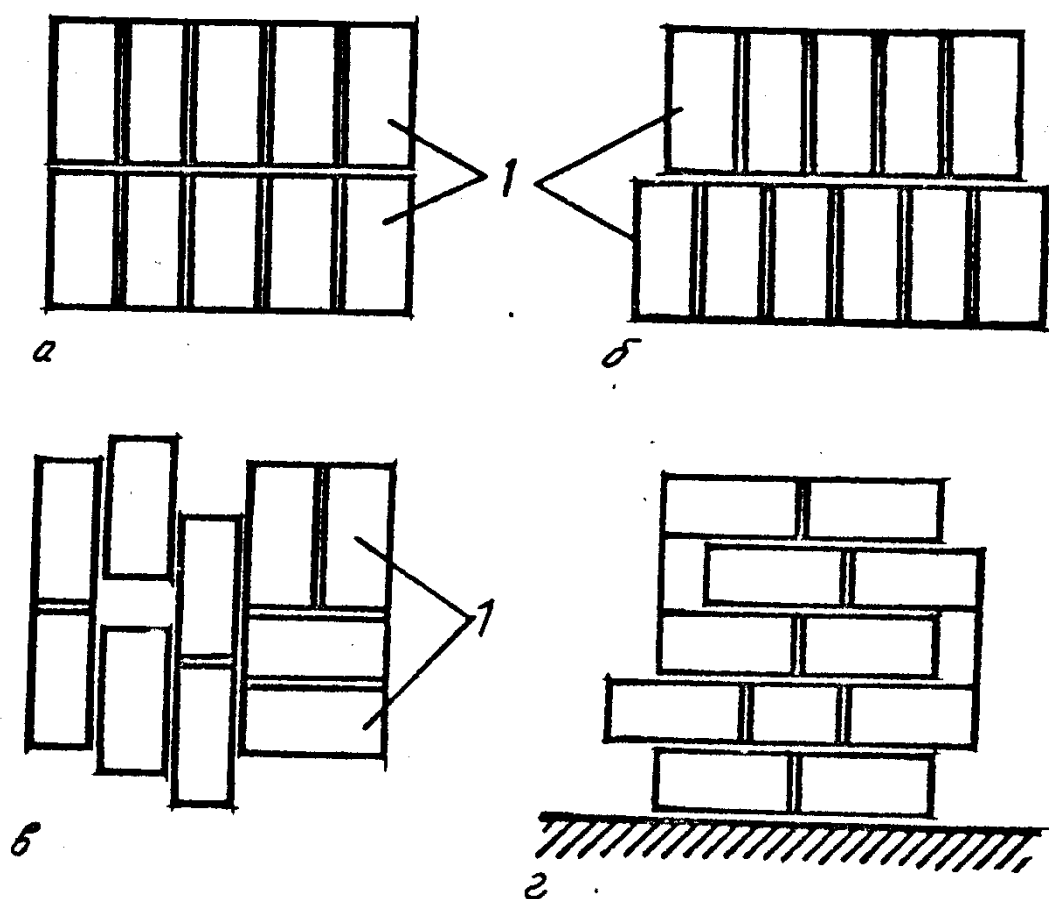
Схеми будівель з об'ємних блоків:
